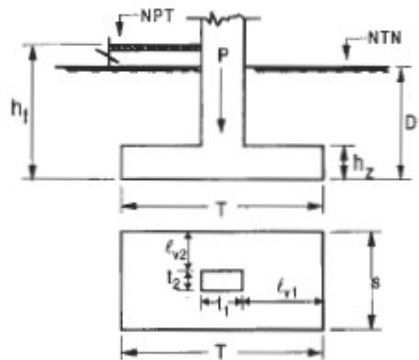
Vista en corte y planta de zapata para la disposición de sus elementos.
